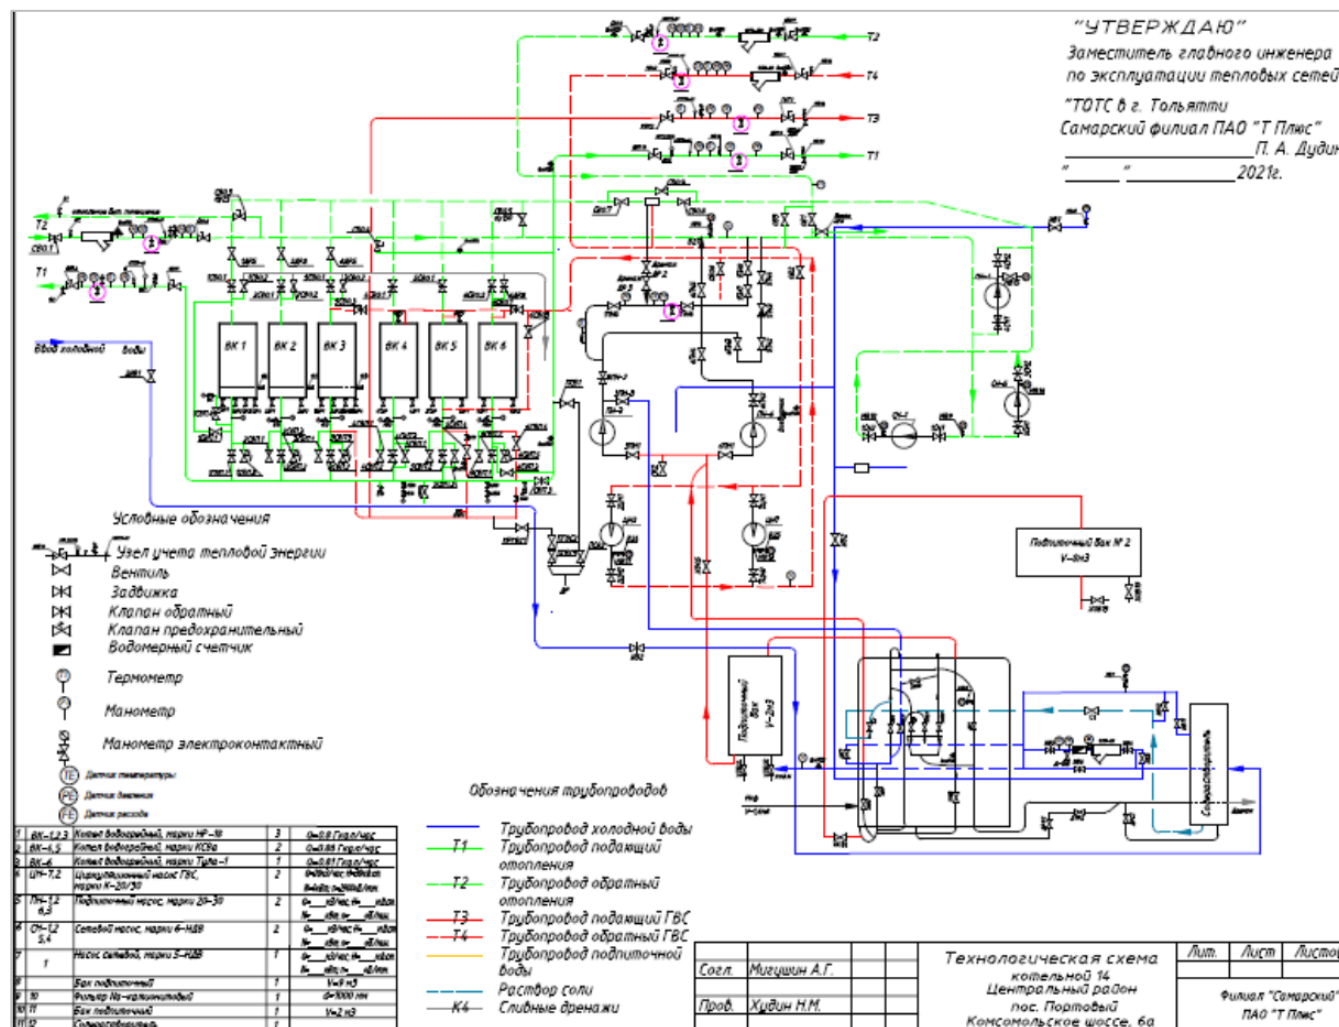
Принципиальная тепловая схема котельной №14
